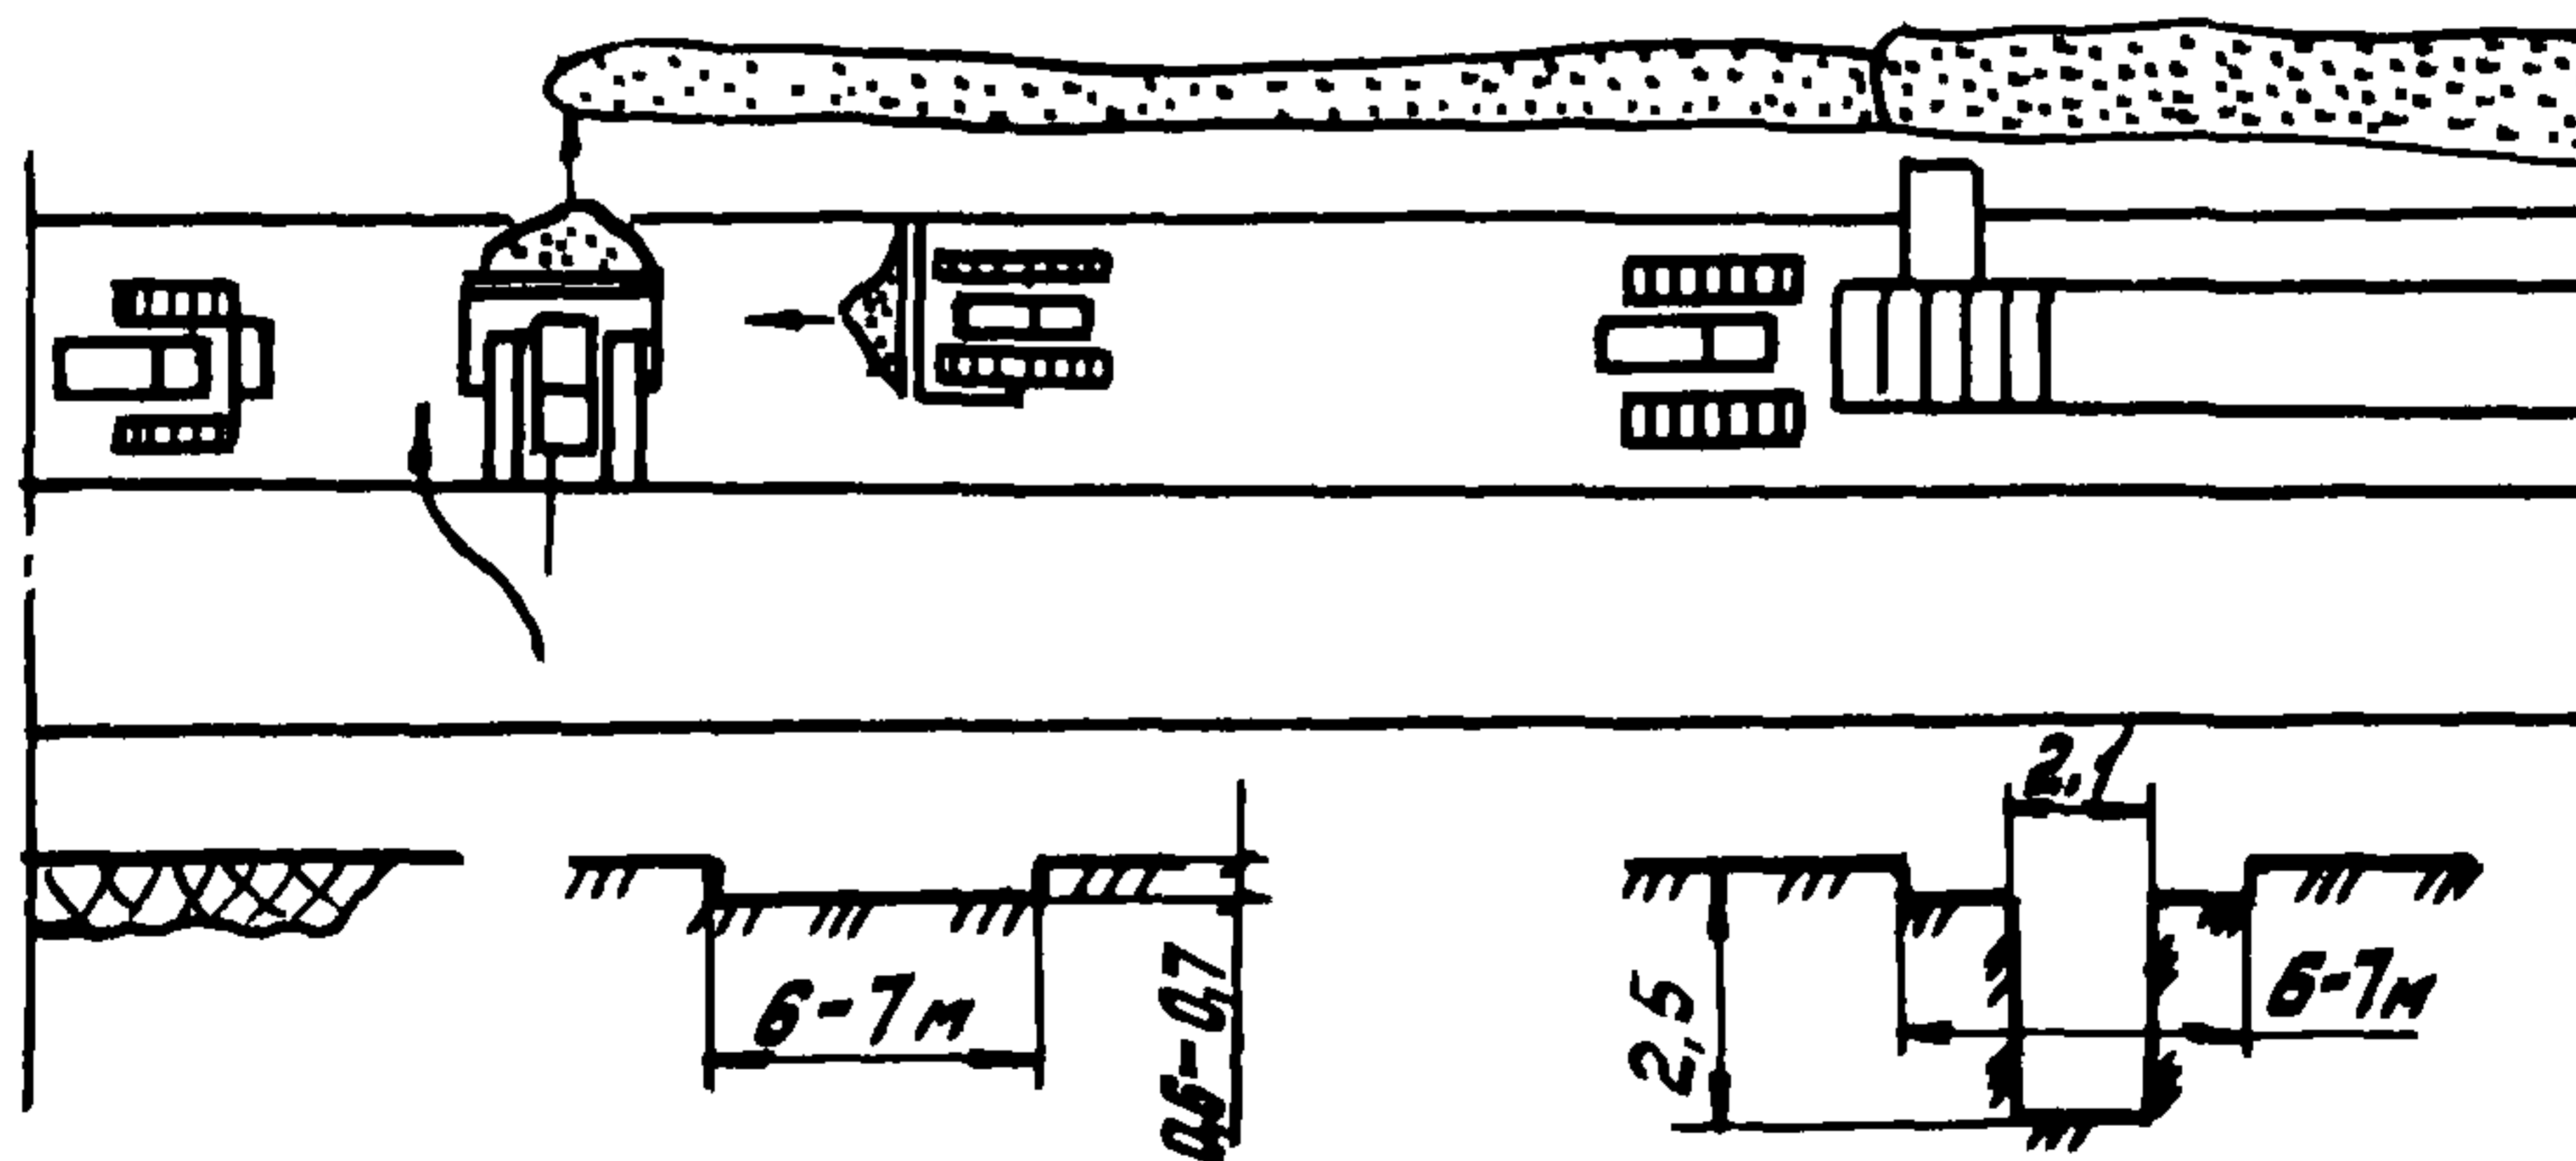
Разработка траншей в мерзлых грунтах для пригружаемых трубопроводов с использованием нетканых синтетических материалов
